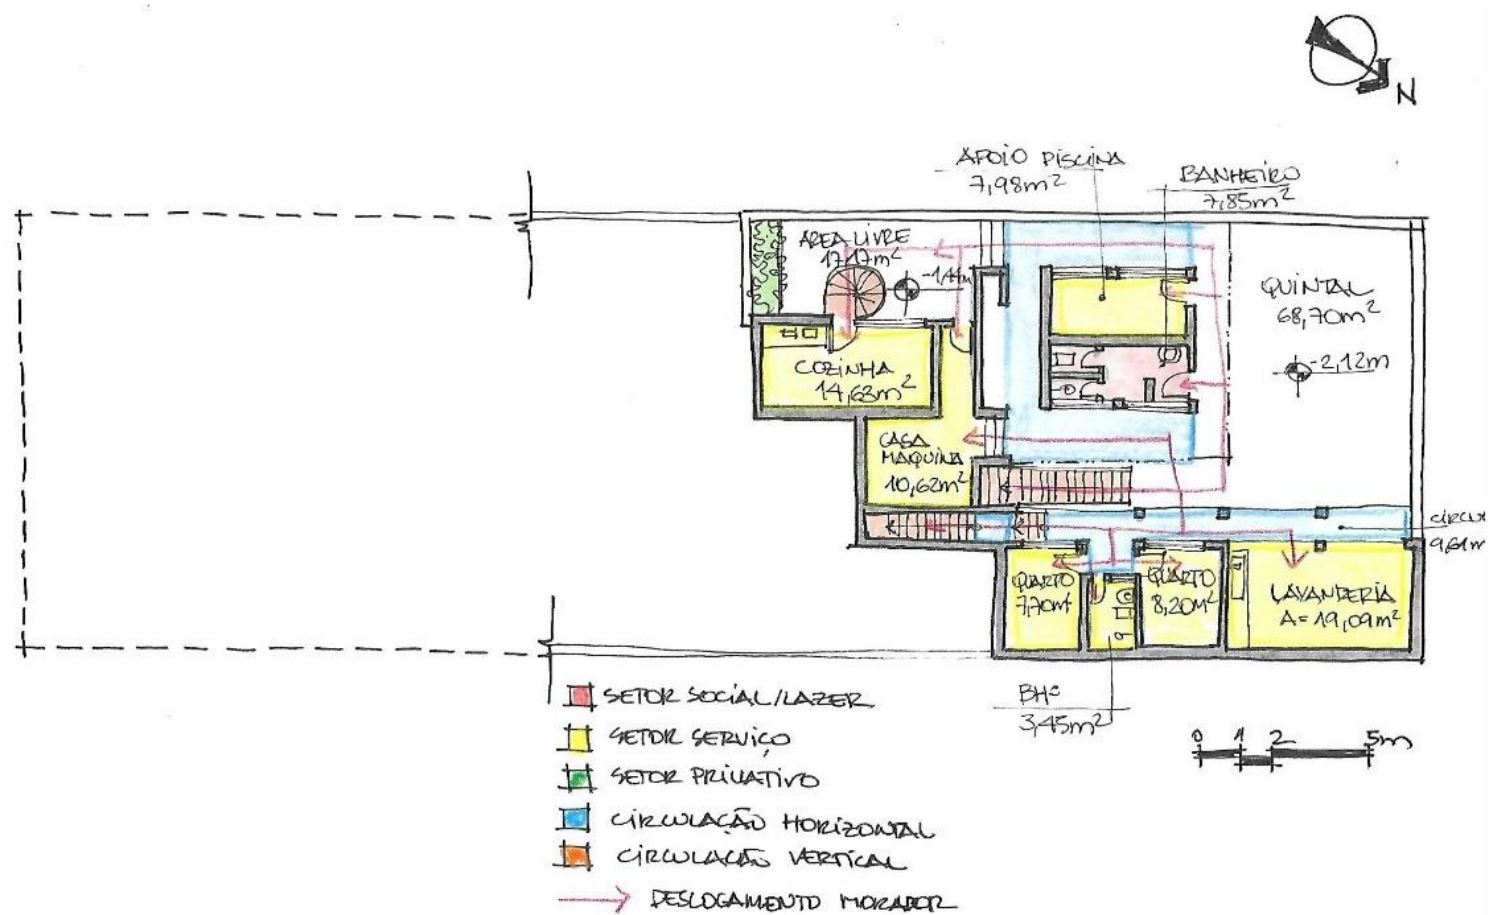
Planta baixa do pavimento inferior da Residência Nº 1.831 (Década de 1960). Fonte: autora, 2019.
